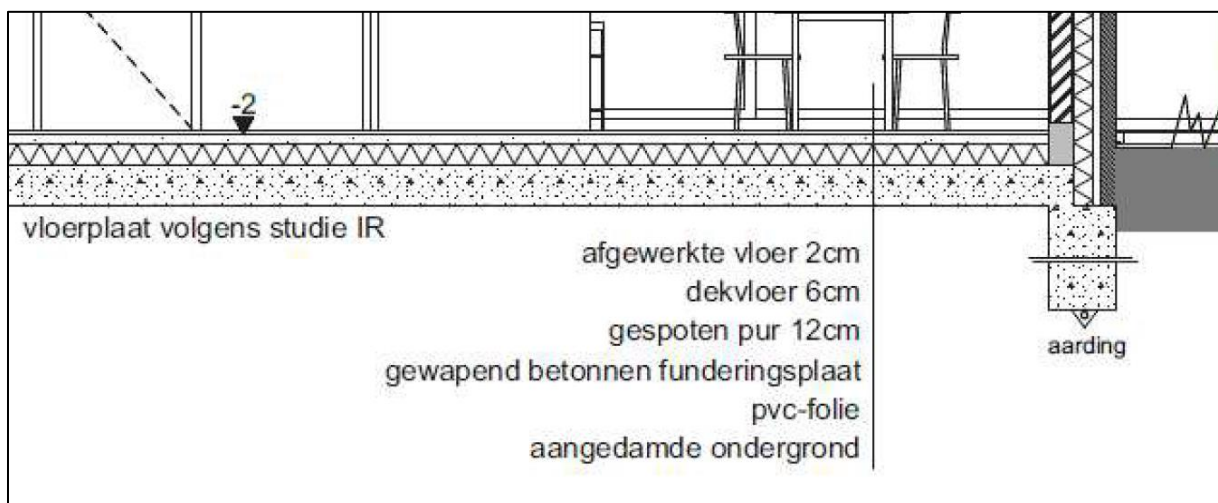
detail uit het doorsnedeplan van de woningen met aanduiding van de funderingsopbouw © architect N. Cornelissen
